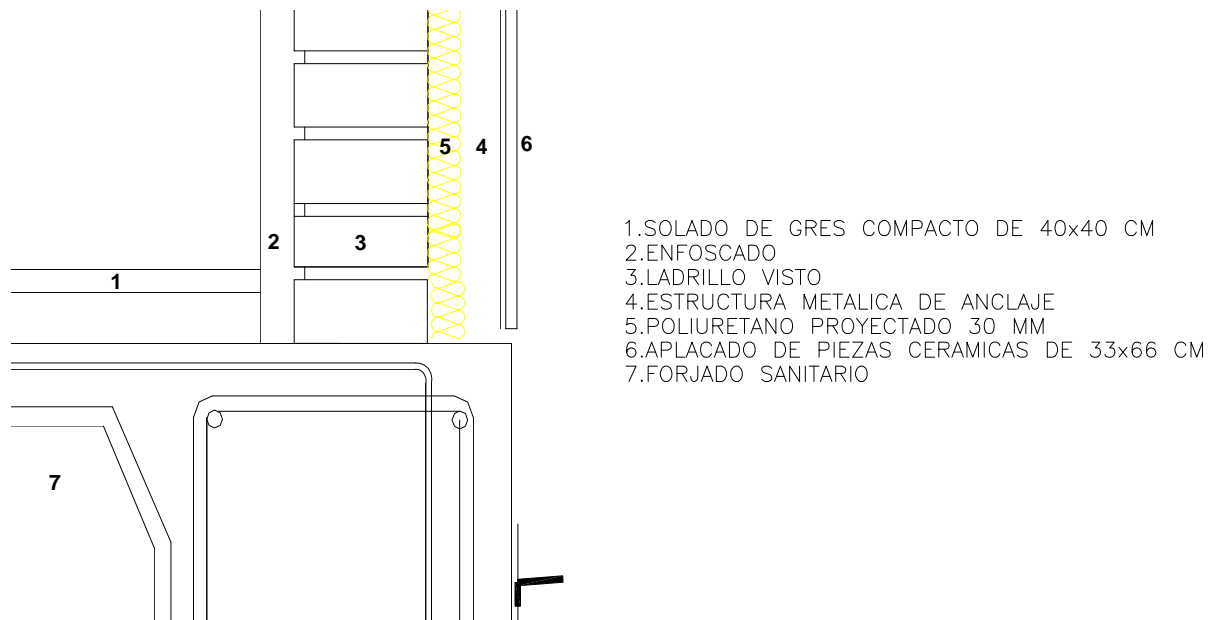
Detalle constructivo de la junta a nivel de suelo de la fachada ventilada de juntas abiertas objeto de estudio
